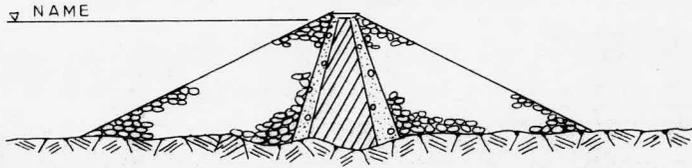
Sección de cortina de enrocamiento, corazón vertical.
